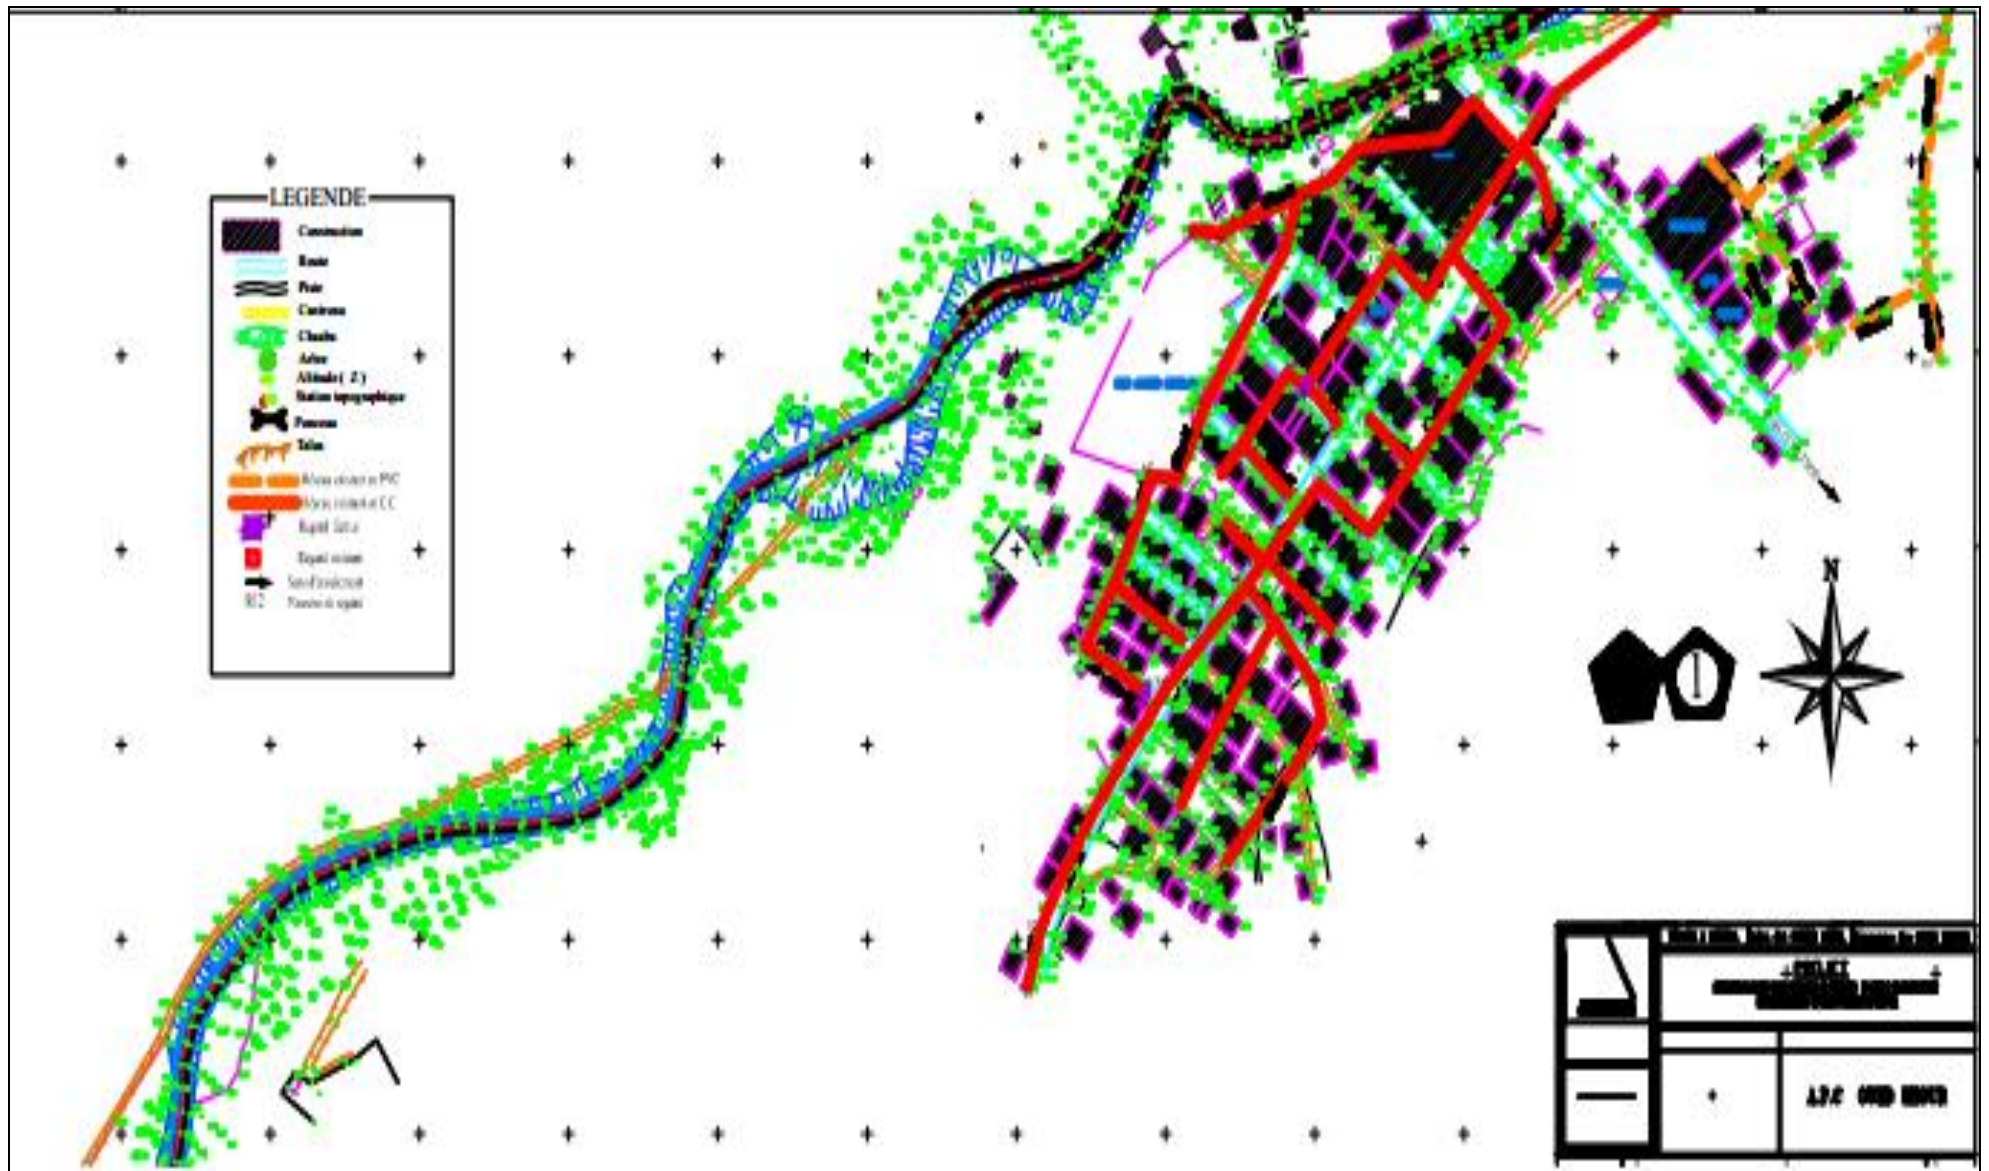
Tracé en plan du réseau existant Rekouba –Oued zhor
